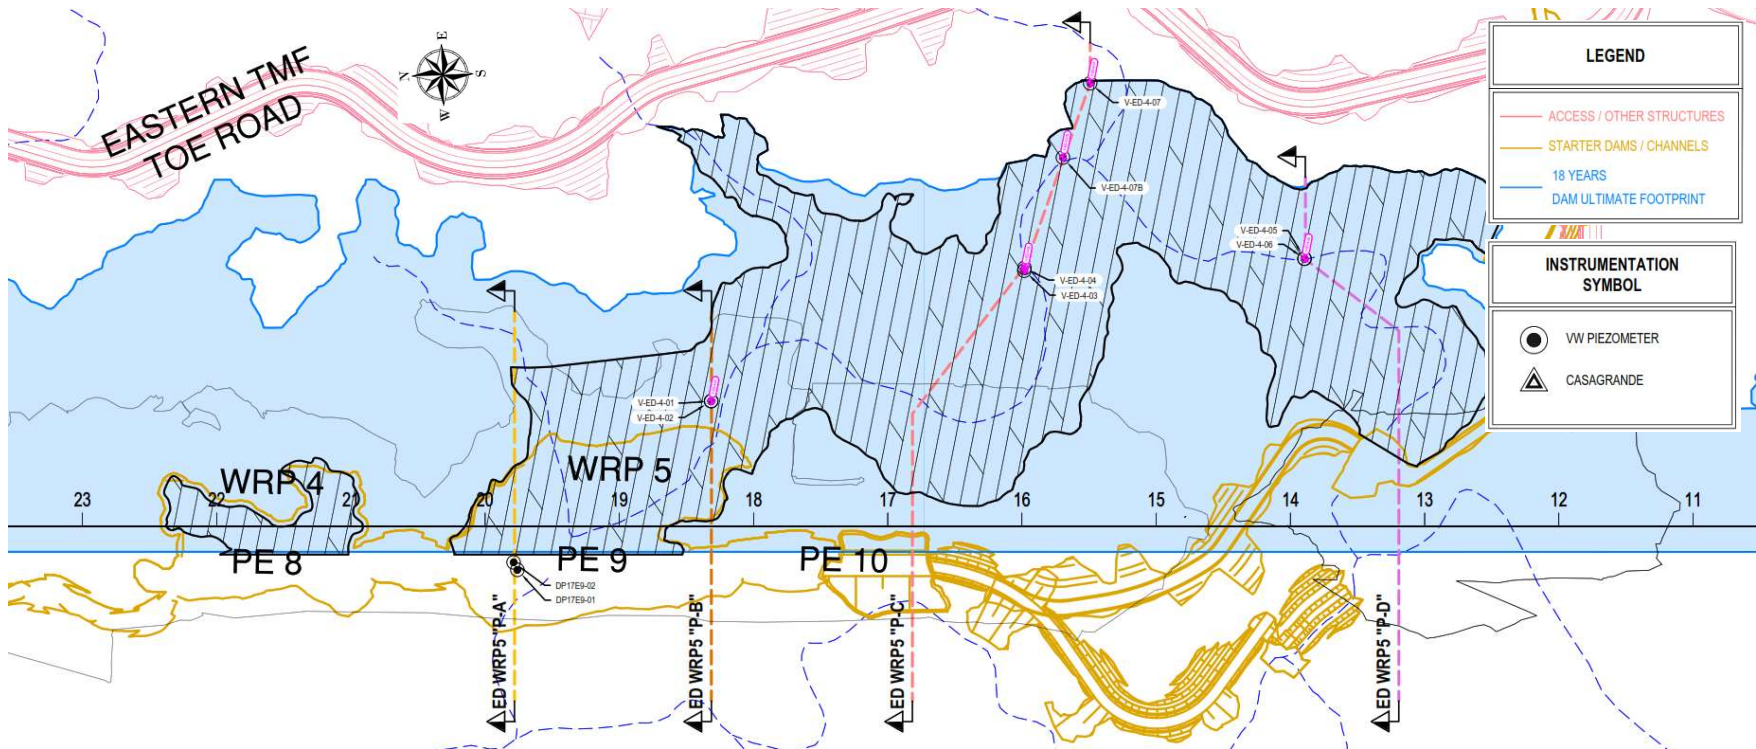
1: Vista en planta de PE WRP5 – Grupos de instrumentos Piezometro y Casagrande
